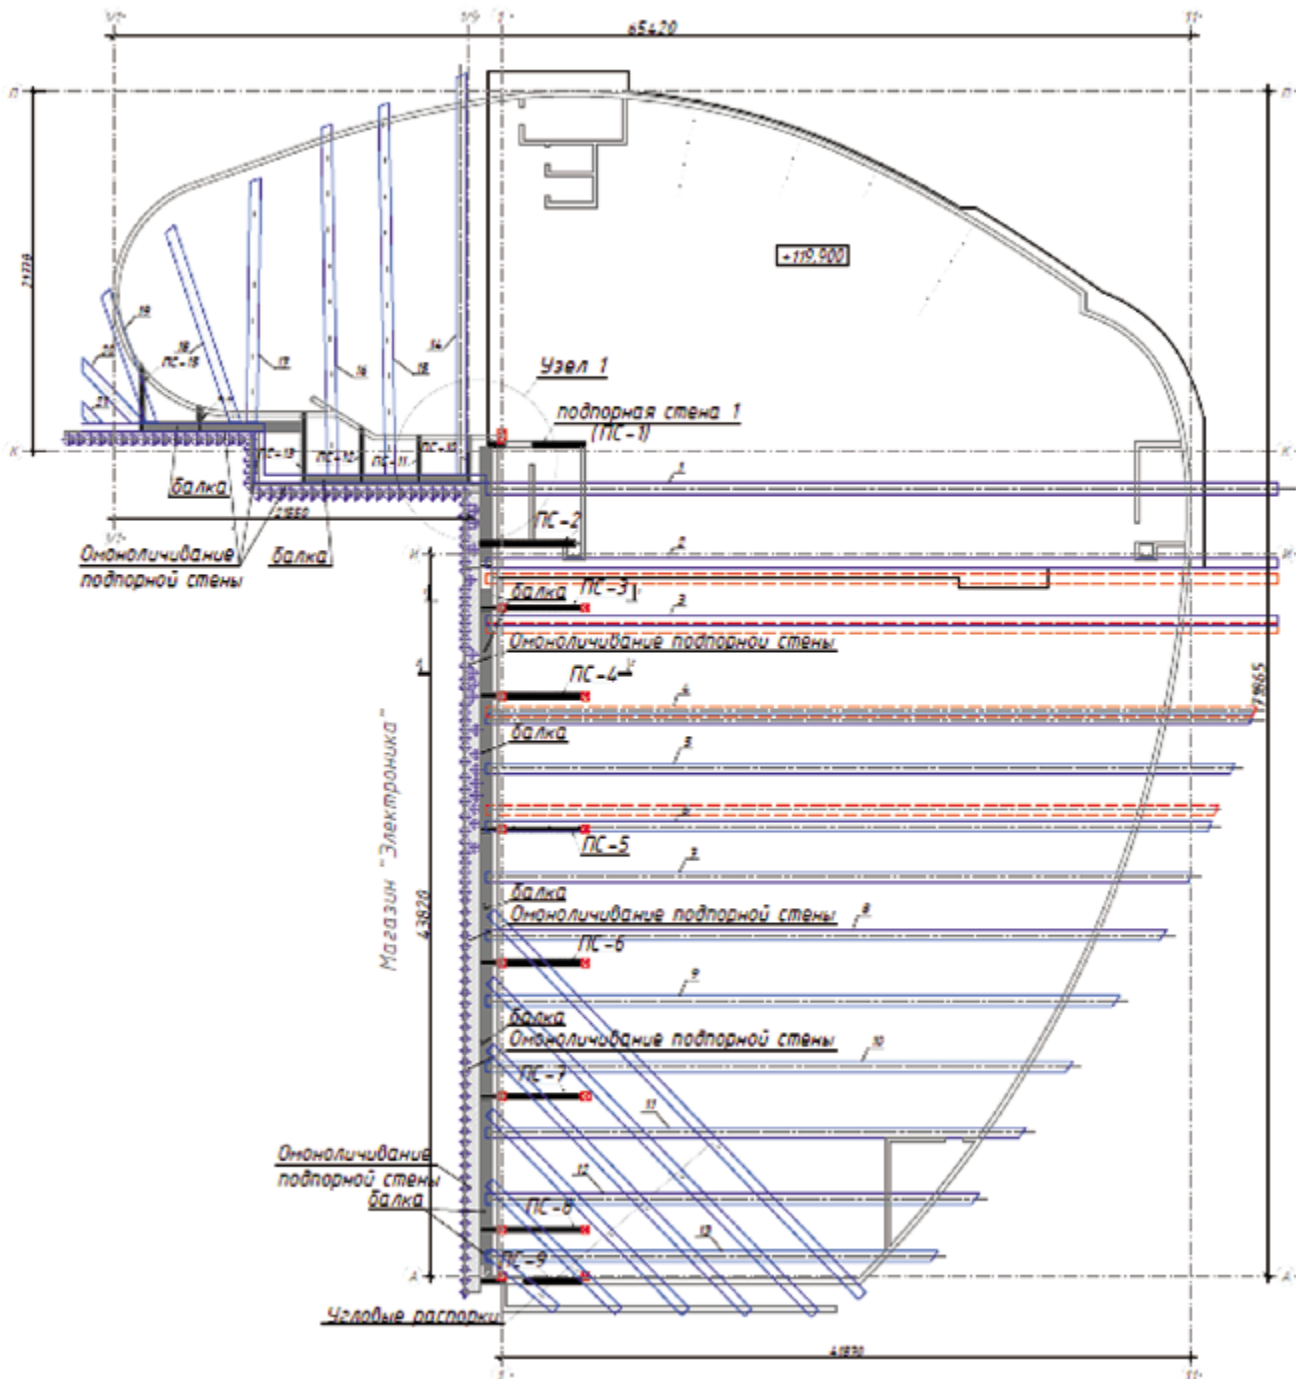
План размещения распорных конструкций для усиления подпорной стены котлована
